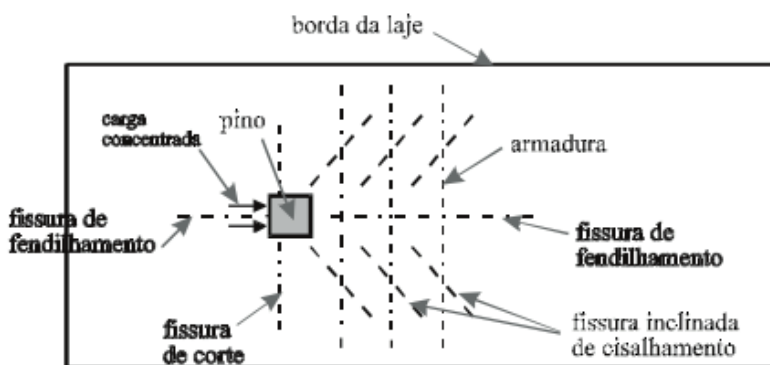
Fissuras de tração induzidas por força concentrada no concreto.
